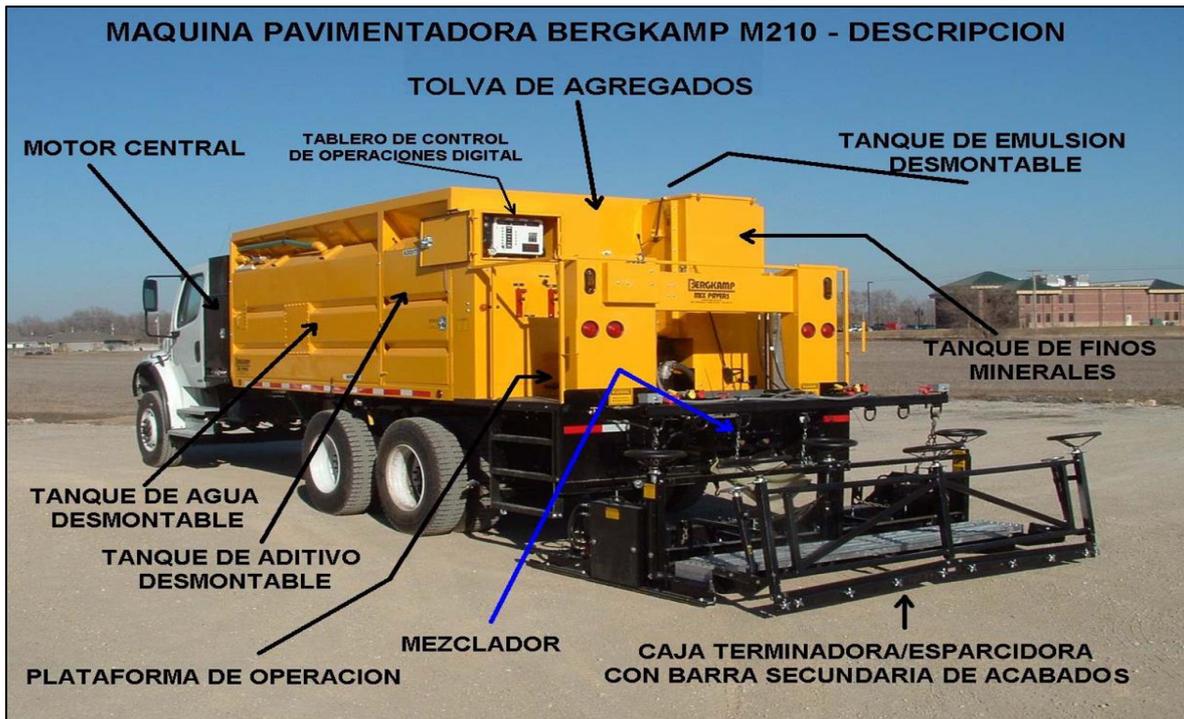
Camión-Planta para aplicación de MPAF (Fuente: Bergkamp Inc.)
